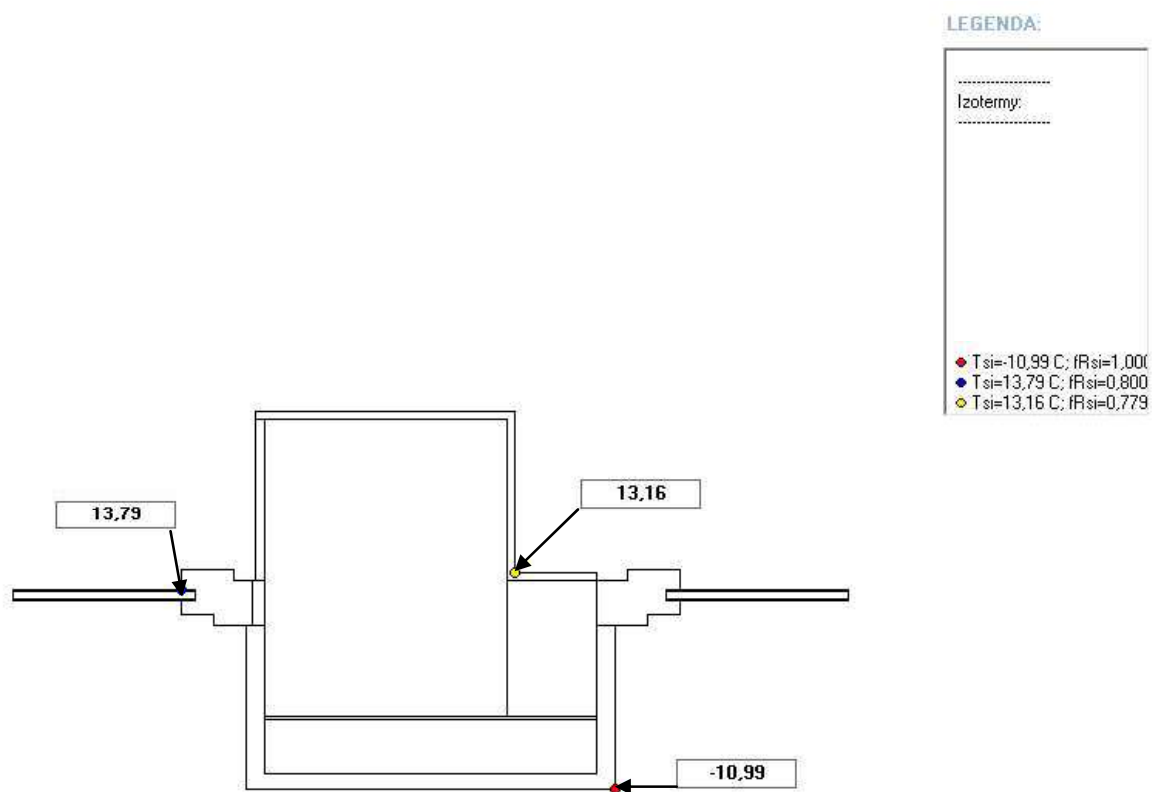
DETAIL HORIZONTÁLNEHO SPOJU OTVOROVÝCH KONŠTRUKCIÍ A STĽPU- NOVÝ STAV
